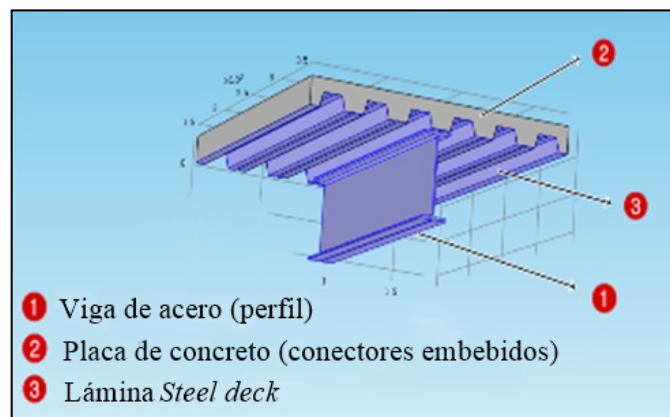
Sistema de losa en sección compuesta con nervios de la lámina paralelos al eje de la viga (después de fundir el concreto). Fuente: Autor
